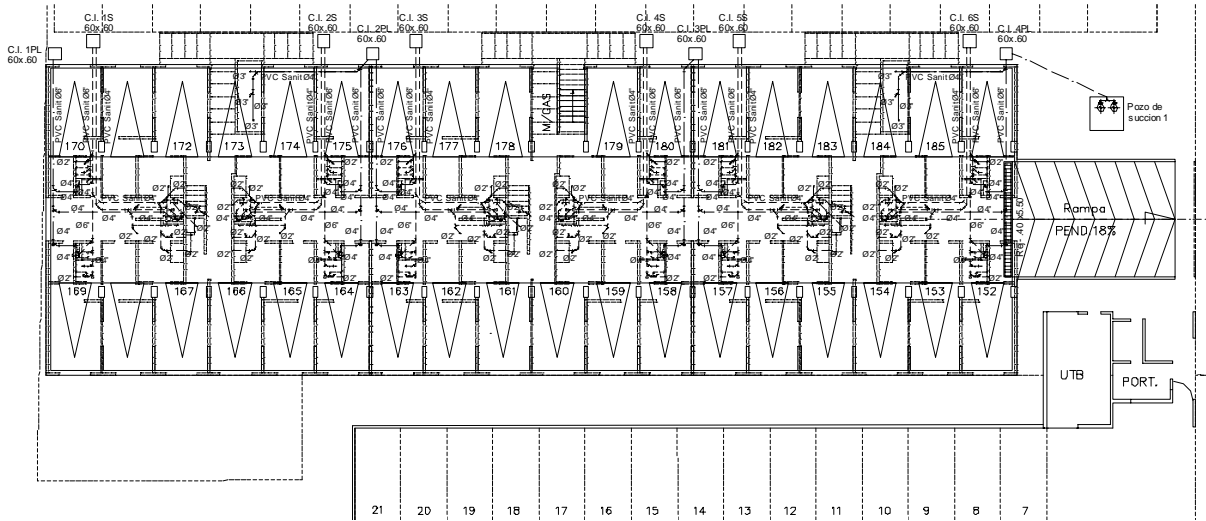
Alcantarillado pluvial y sanitario Torre A-B-C
